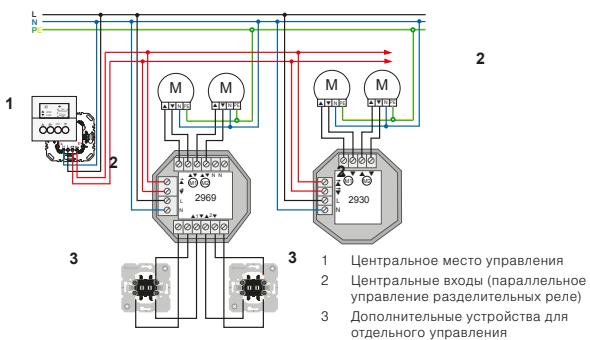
Схема подсоединения разделительного реле для наружного и скрытого монтажа
